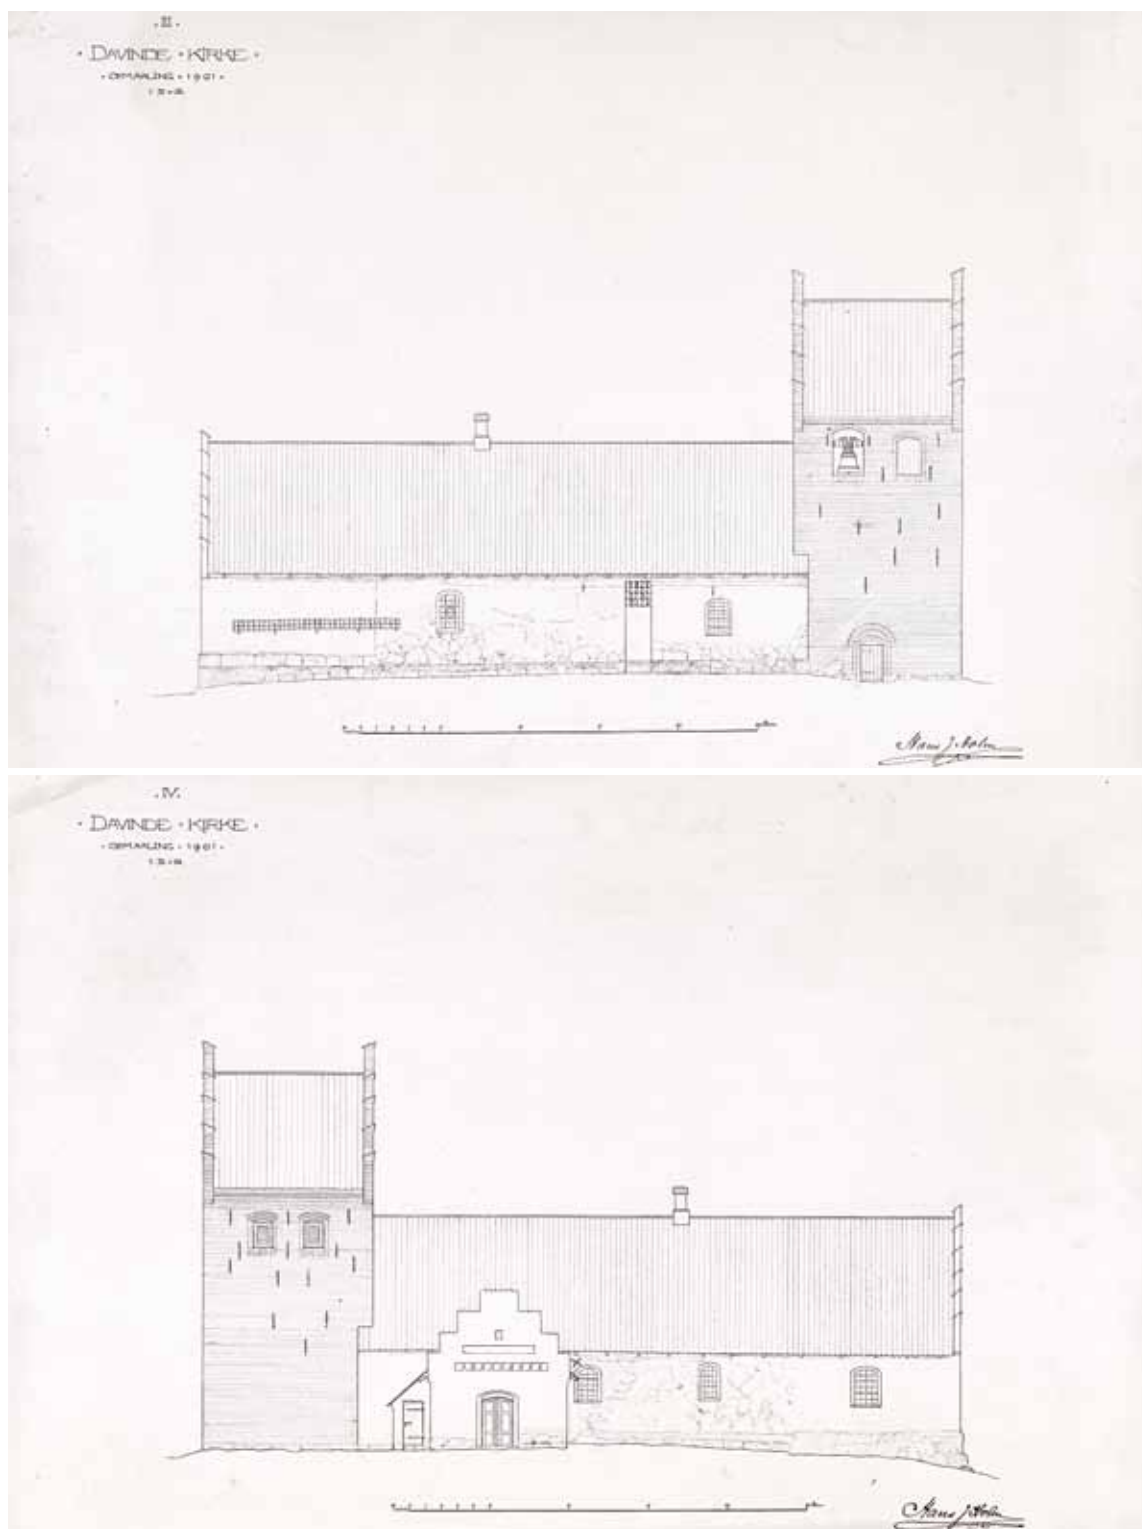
d. Opmålinger. 1:300. c. Opstalt af nordfacade. 1:300. d. Opstalt af sydfacade. Målt og tegnet af Hans J. Holm 1901. I Sanderumgårds arkiv. – c. *Elevation of north facade.* d. *Elevation of south facade.
